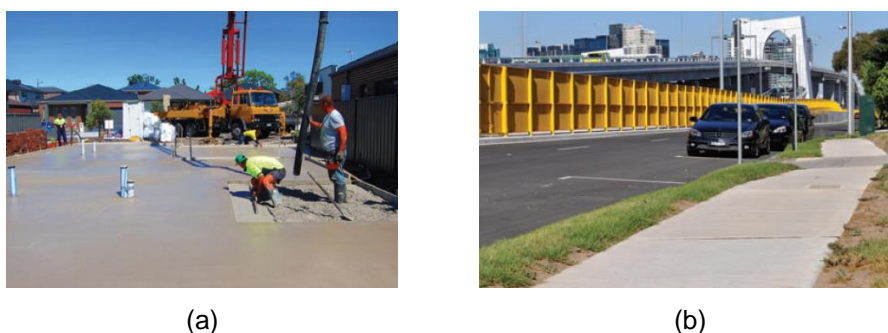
(a) Laje de piso residencial (b) calçada.
